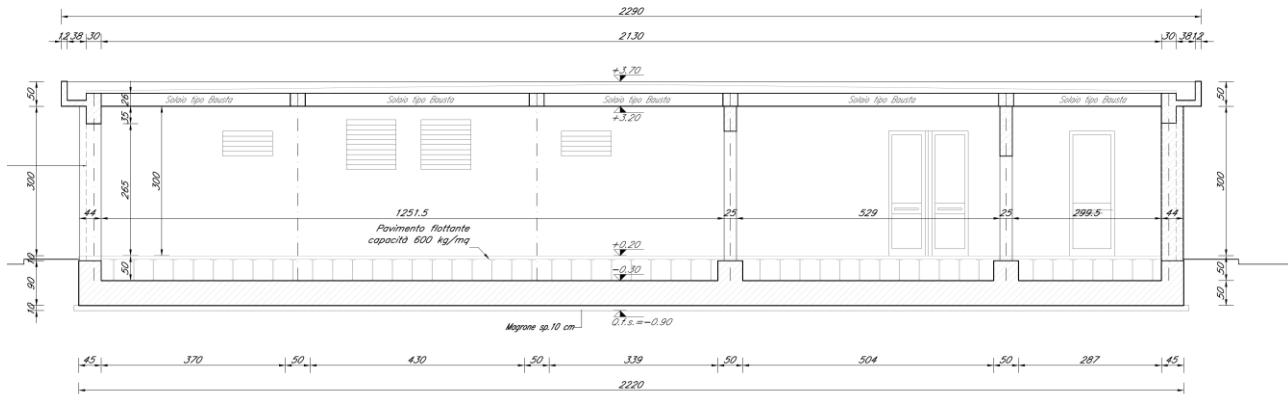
Sezione longitudinale fabbricato tecnologico CdM
